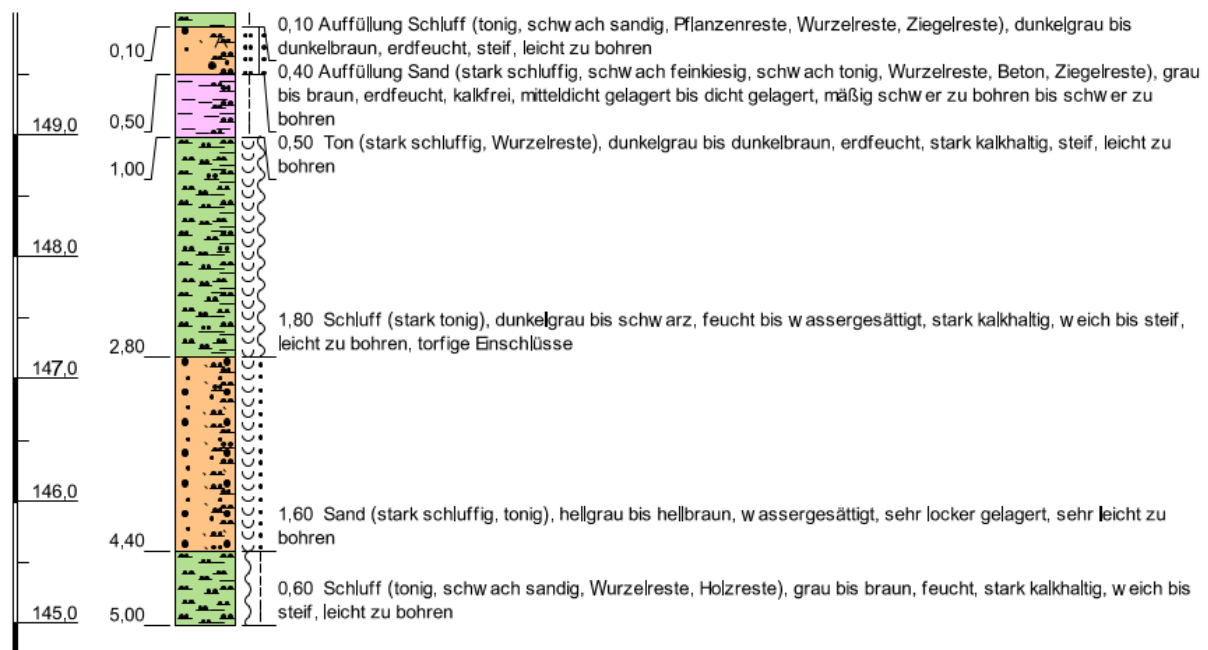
für die Baugrube maßgebender Baugrundaufschluss
